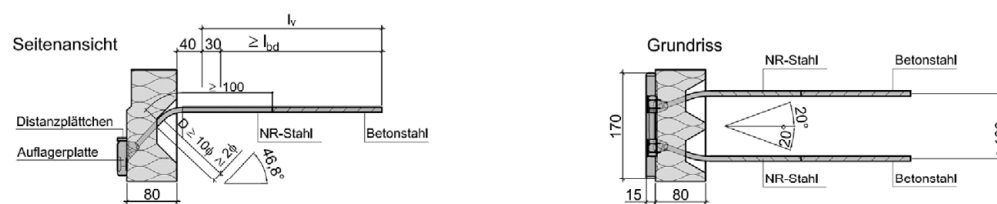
Querkraftstäbe 2 × Ø 8 mm inkl. Auflagerplatte
